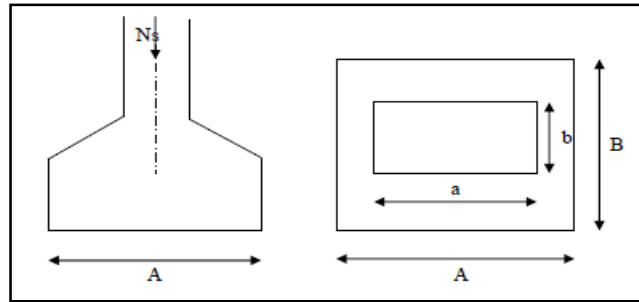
Pré-dimensionnement de la semelle isolée.
